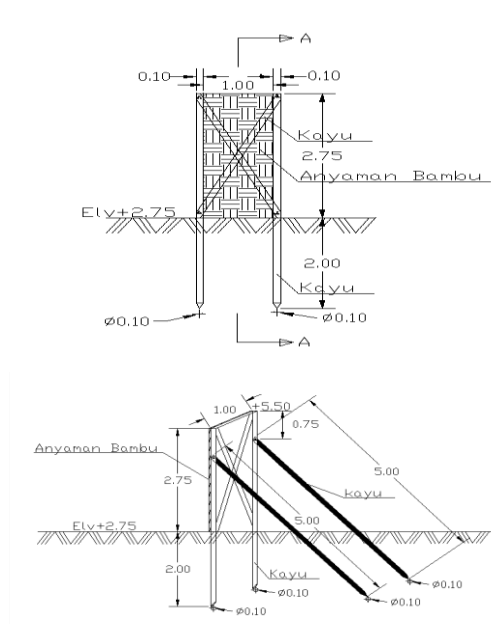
Tipikal Ambang Pemisah Konstruksi Sheetpile-Alternatif 3
